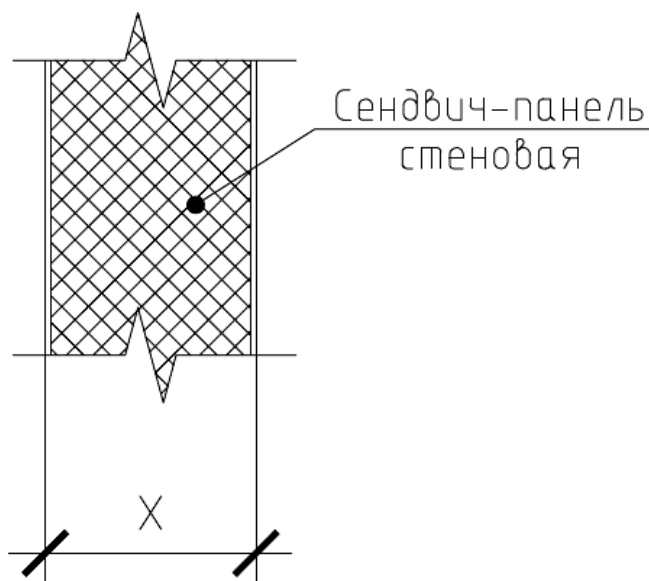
Конструкция наружной стены плавательного бассейна
